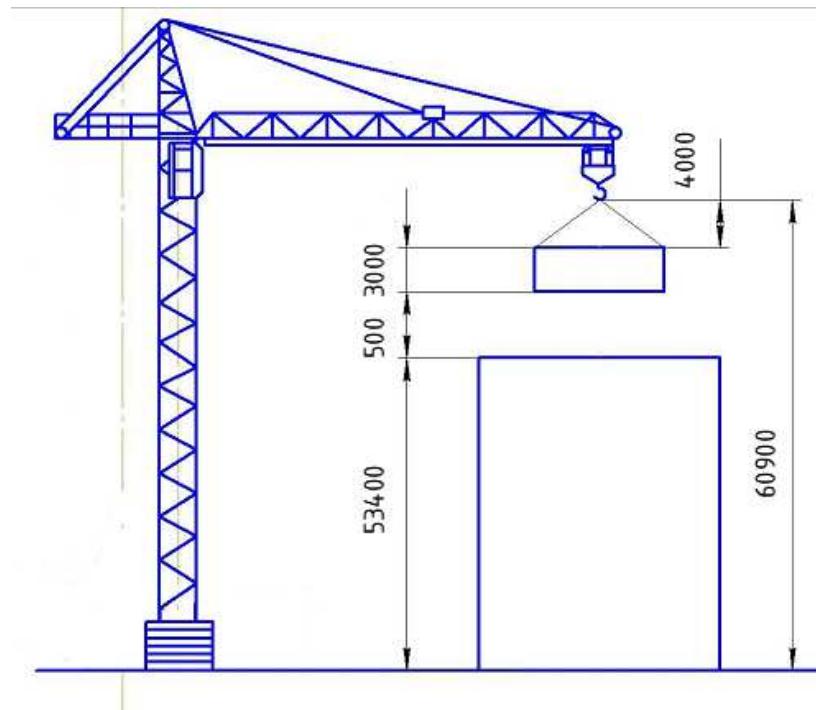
Расчёчная схема крана ТДК-10.215
